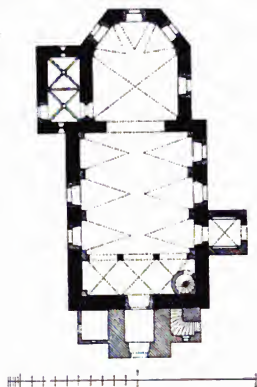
Luttau. Grundriss der Kirche.
